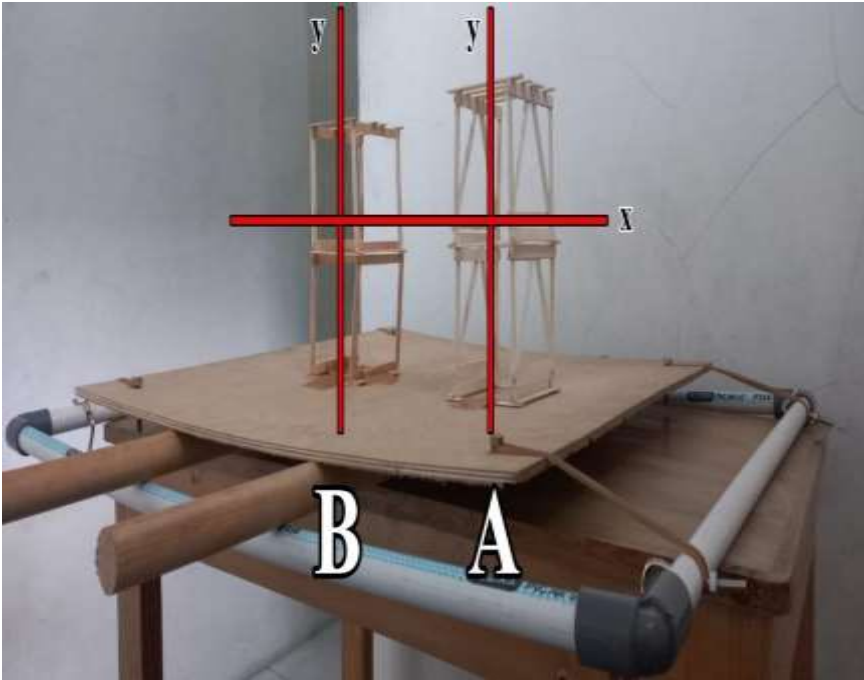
Desain konstruksi bangunan tampak depan
